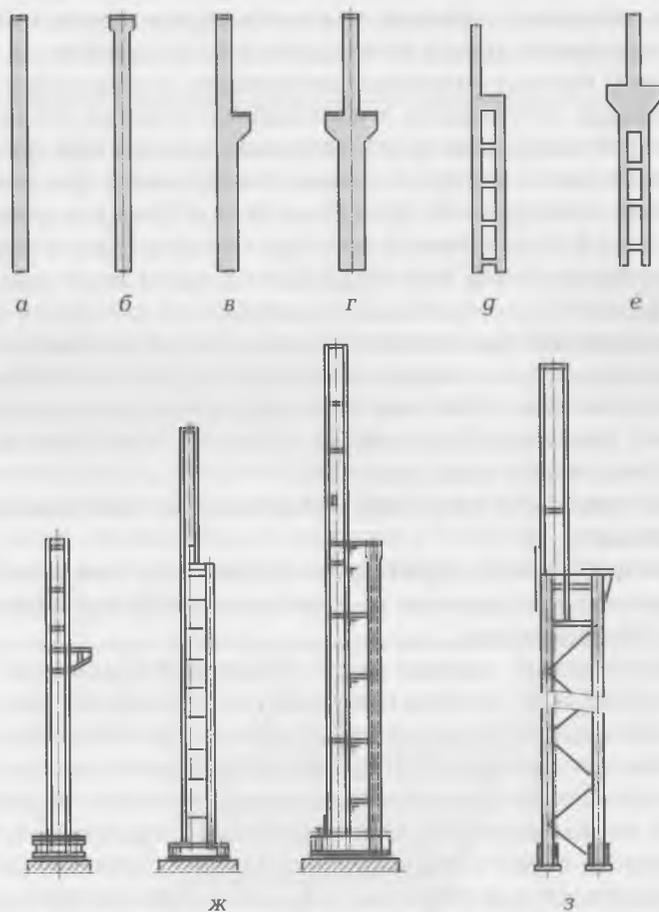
Железобетонные (а—е) и металлические (ж,з) колонны: а — сплошные крайних рядов; б — сплошные средних рядов; в — сплошные крайнего ряда с консолью; г — сплошные средних рядов; д, е — двухветвевые; ж — сплошные постоянного и переменного сечения; з — сквозные переменного сечения
